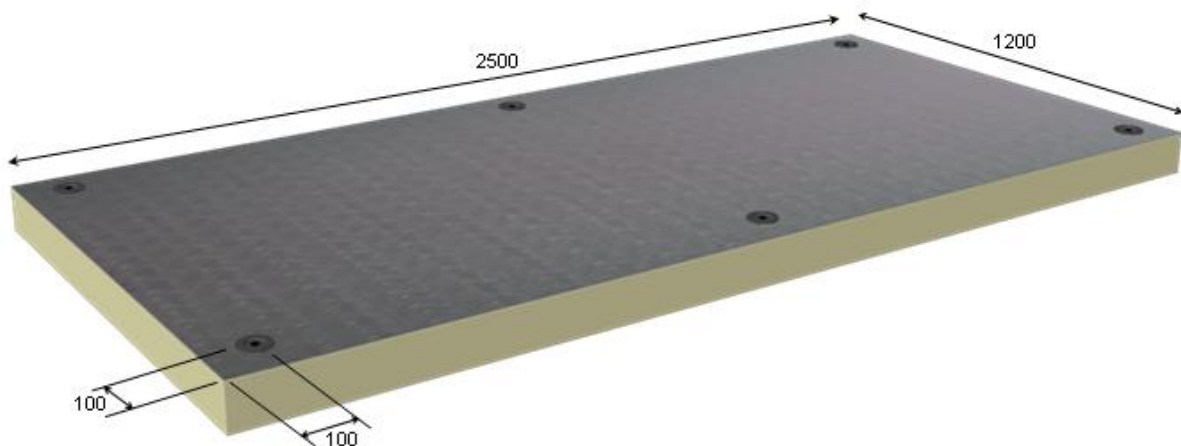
Planchas 2500x1200mm: 2 fijaciones/m<sup>2</sup>.
